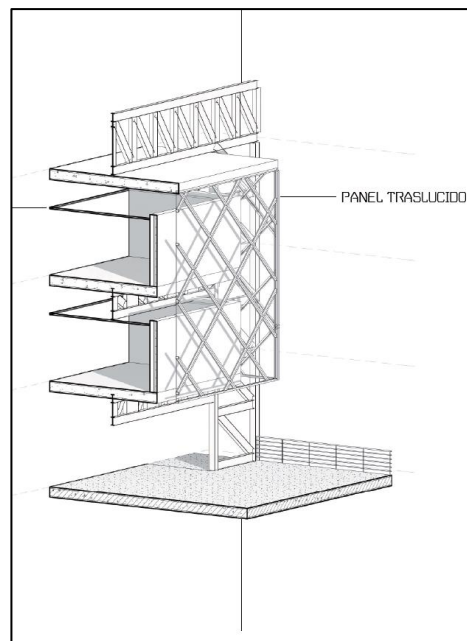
Axonometría detalle de Módulo M. Elaboración propia.
